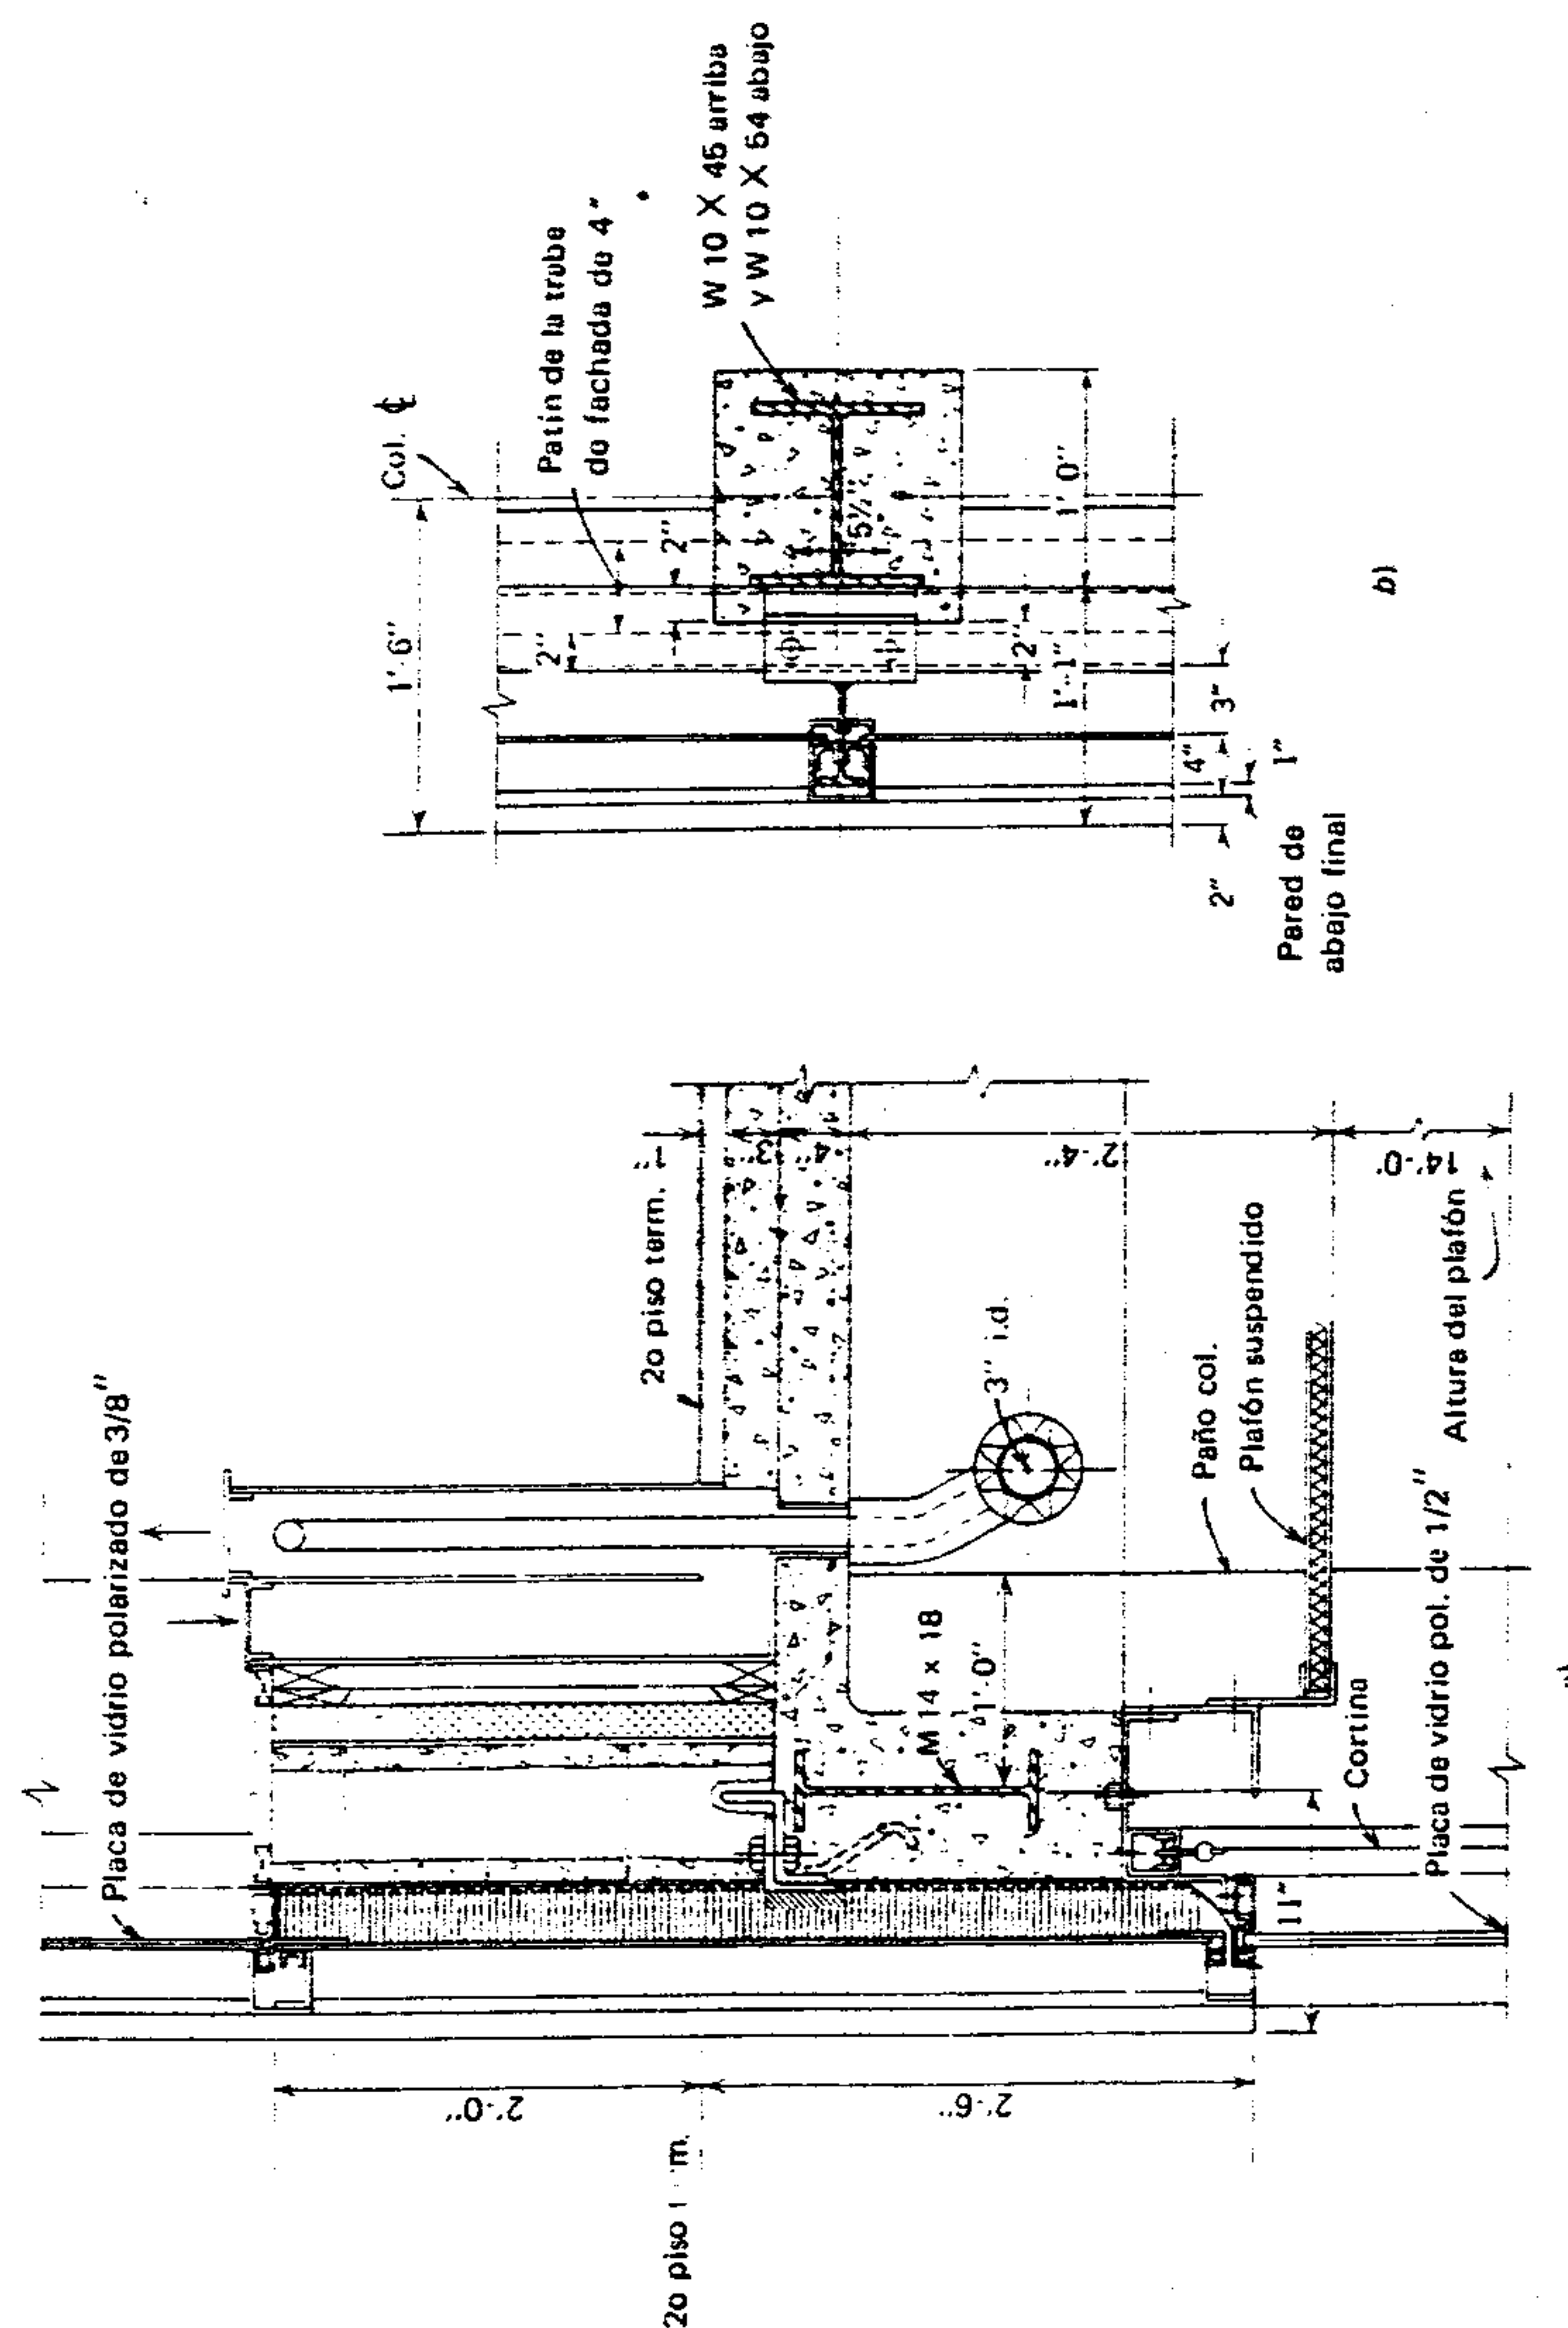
Viga de fachada del muro oeste del segundo piso.
